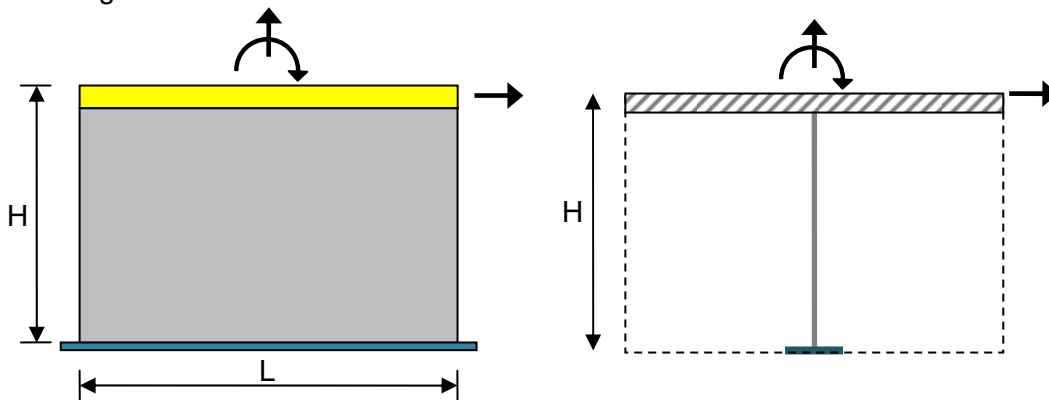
Modelado de Muro: (a) Muro sólido (b) Columna ancha equivalente
